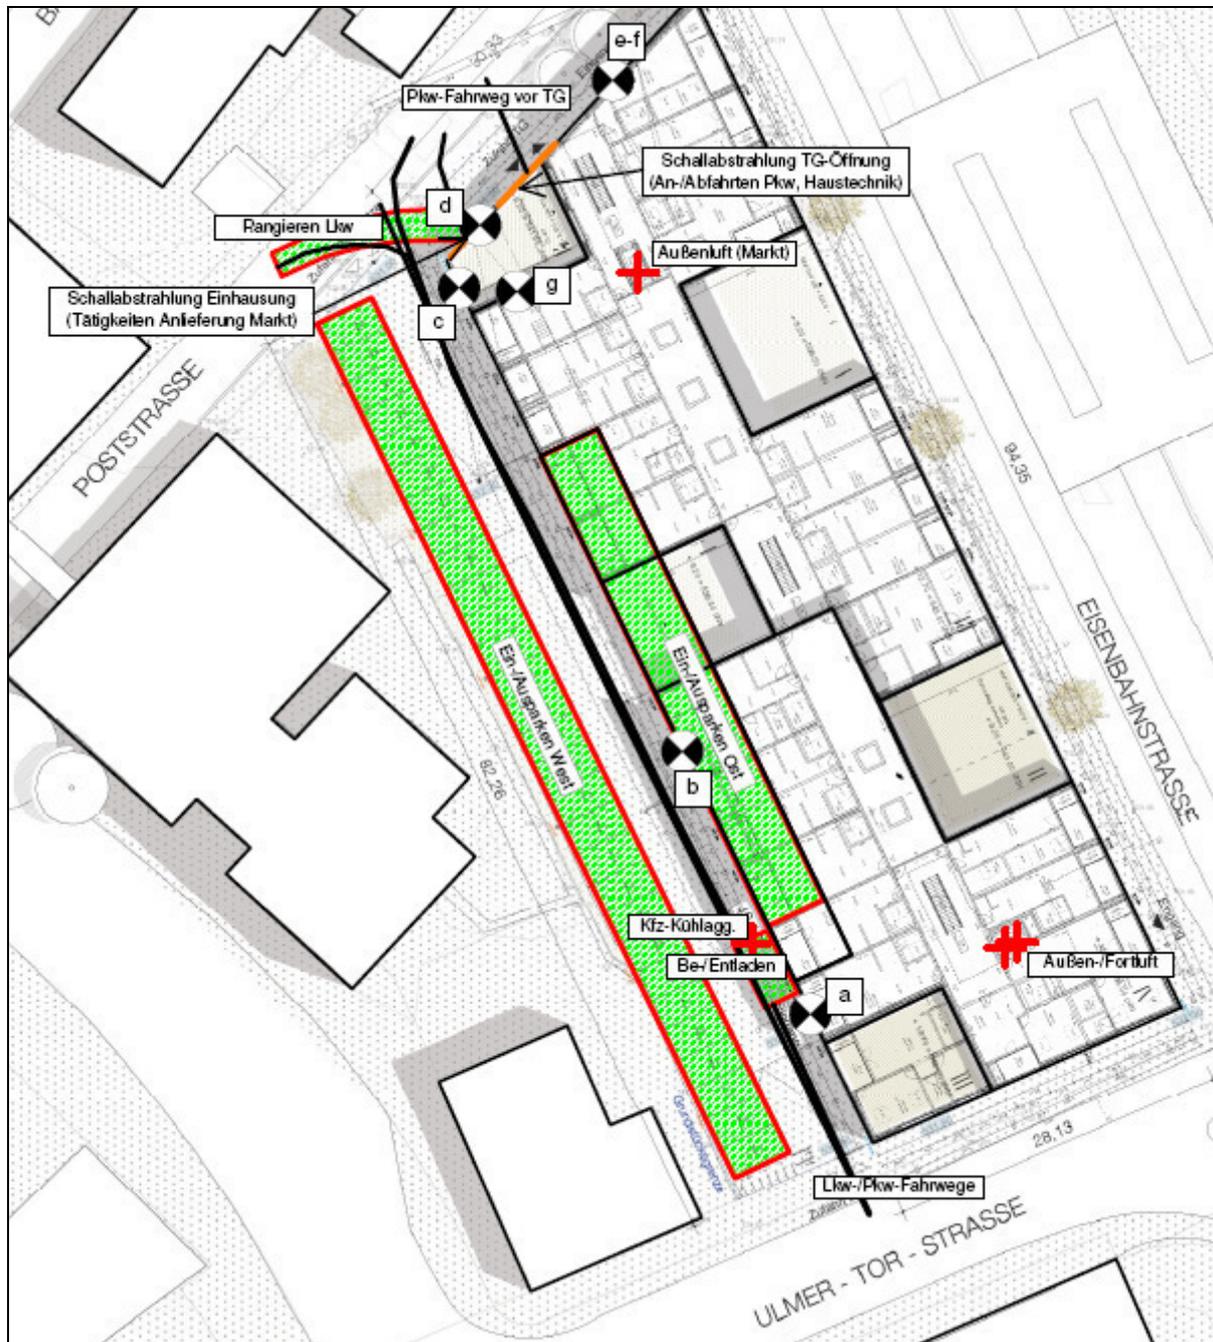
Lageplan (nicht maßstäblich) mit Darstellung der Immissionspunkte a bis g sowie Schallemissionsquellen durch geplanten Gewerbe- und Anlagenlärm
